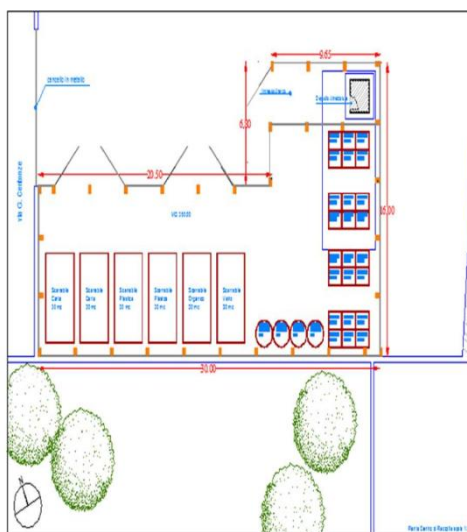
Stralcio planimetrico dell'attuale isola ecologica
